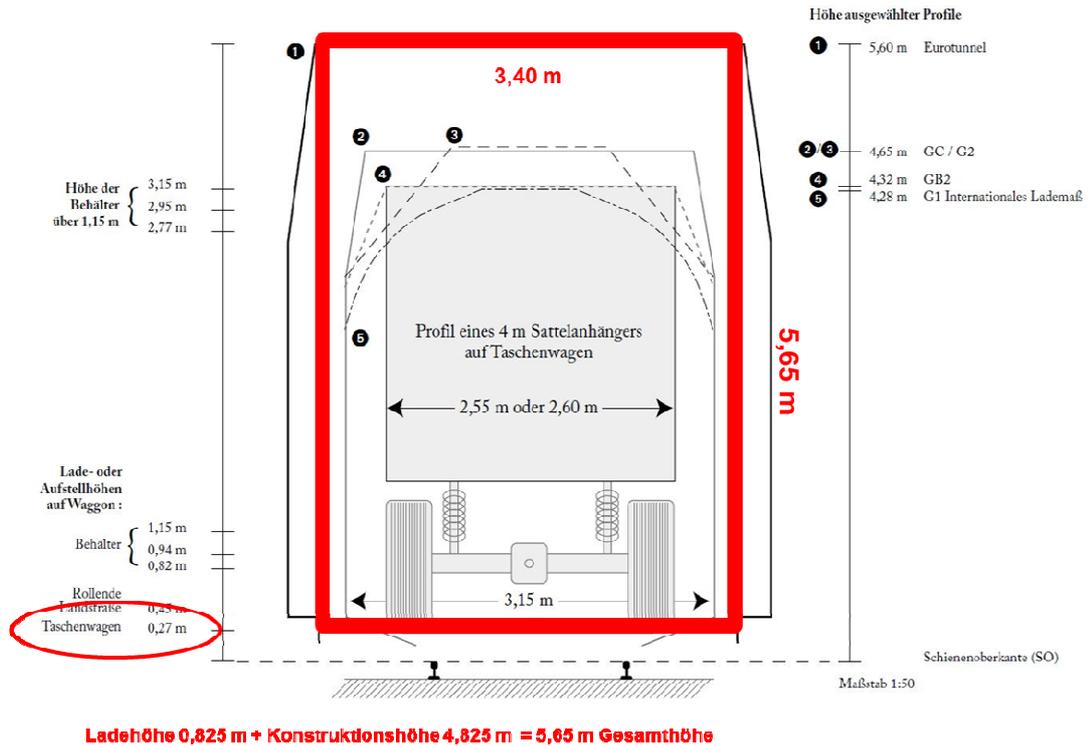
Lichtraumprofil Bahn und Abmessungen Rahmenkonstruktion
